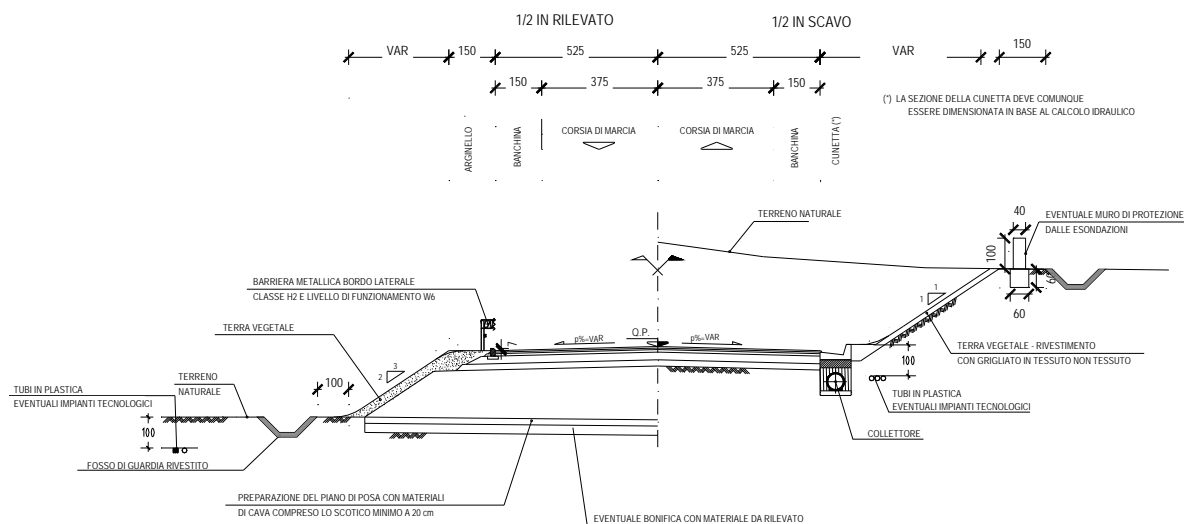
Esempio di sezione di tipo C1 a mezza costa.
